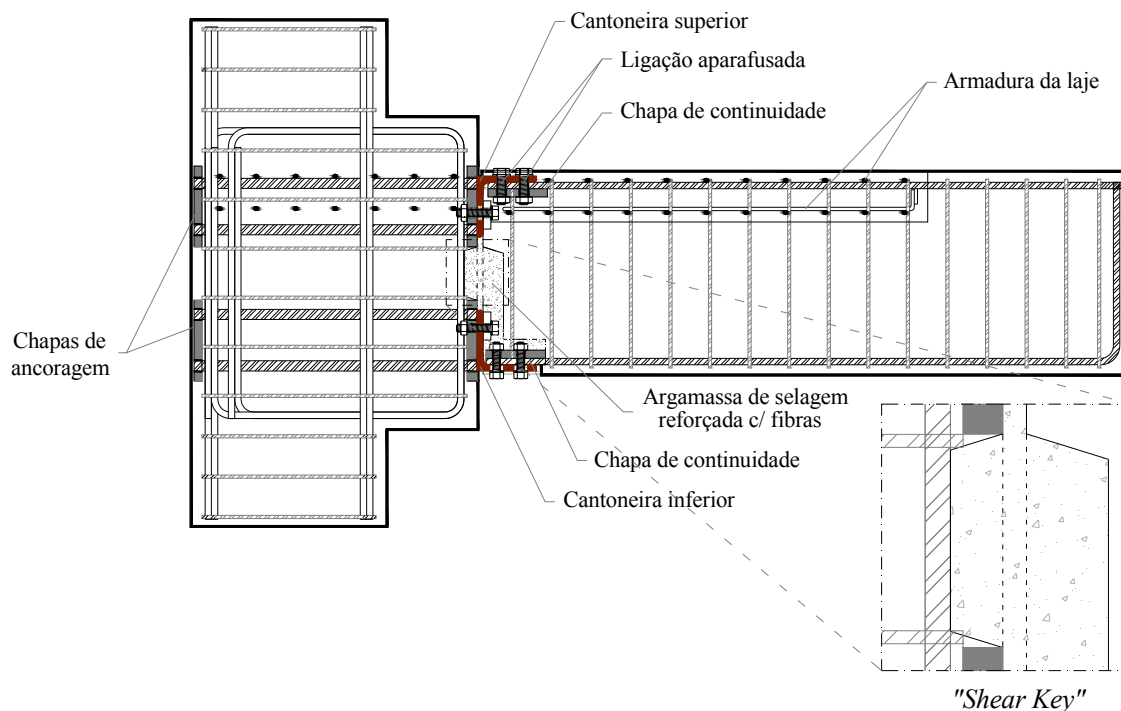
Pormenor da execução do “*Shear Key*”
